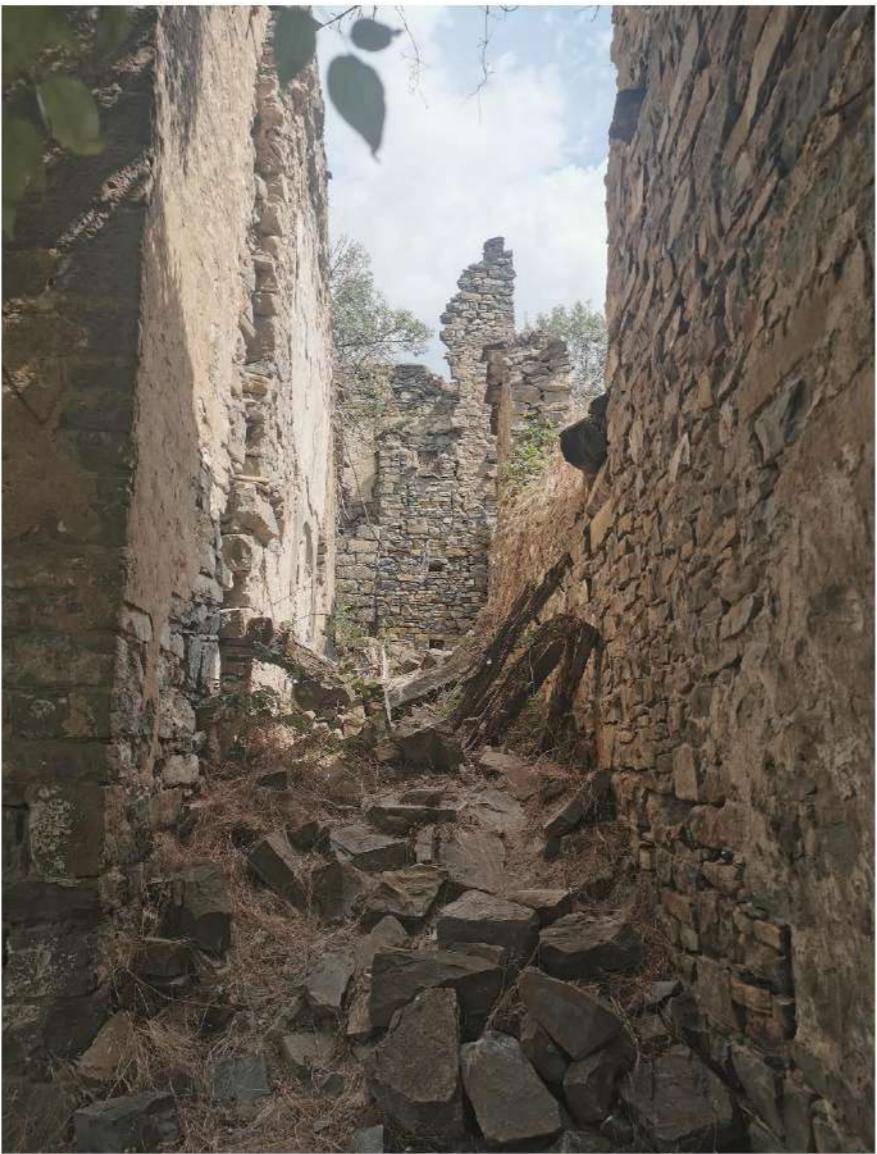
Detalle de los huecos en el muro donde se apoyaba el forjado de las distintas plantas de la edificación. Foto: Autor
